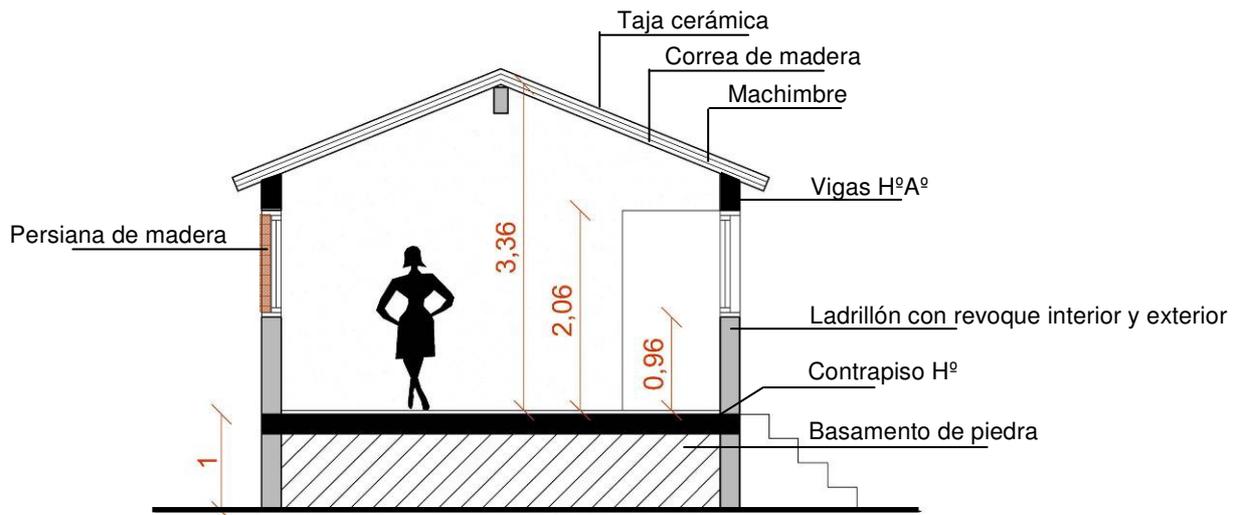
Corte esquemático. La vivienda se asienta sobre un basamento sólido de piedra.
